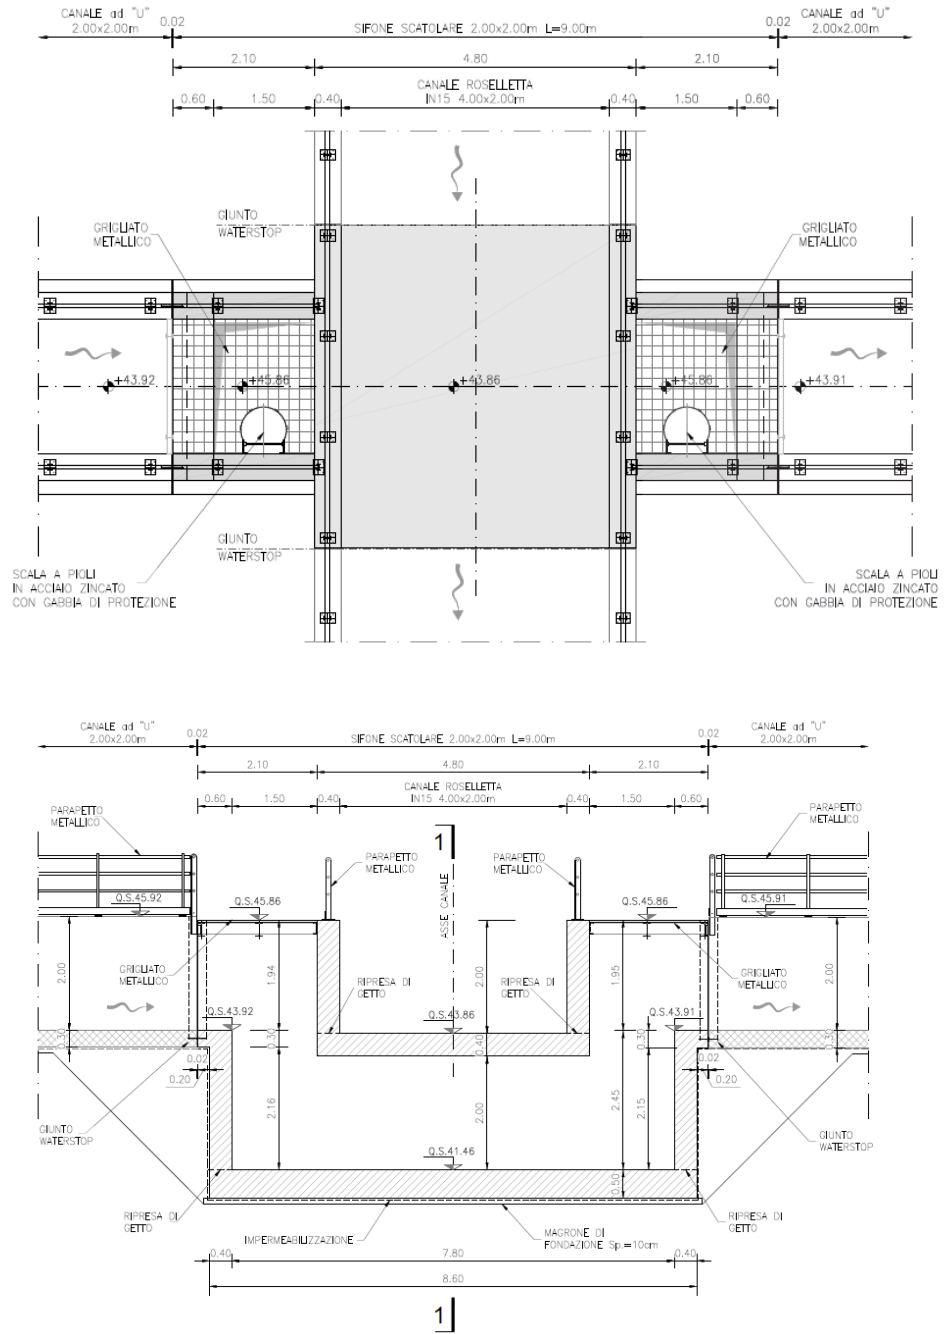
Pianta e sezione longitudinale del sifone 2.00x2.00 IN14 – IN15
